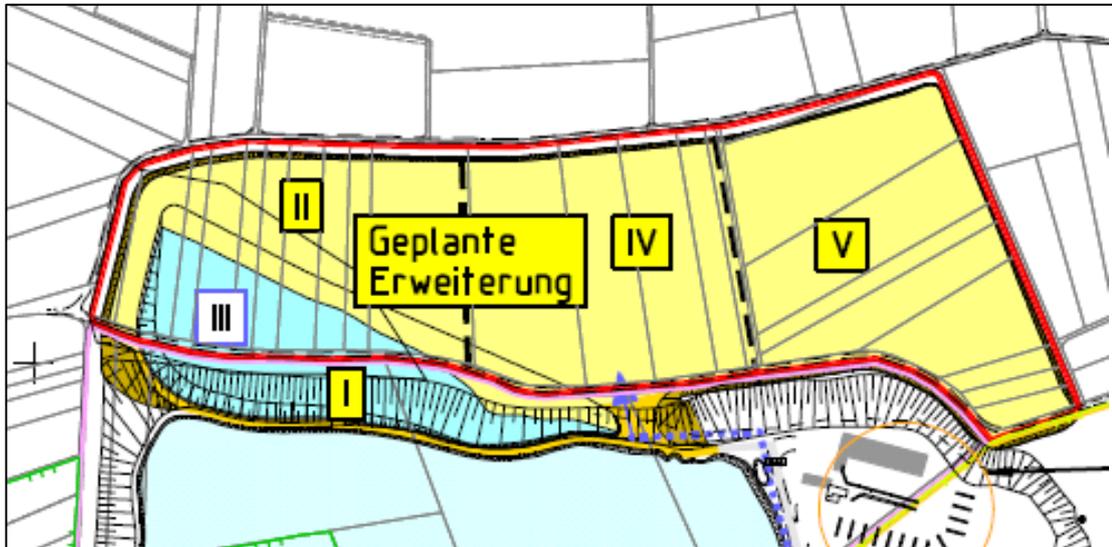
Im Zuge der Erweiterung geplante Abbaustufen (s. auch Plan 1.2, M 1:5.000)
